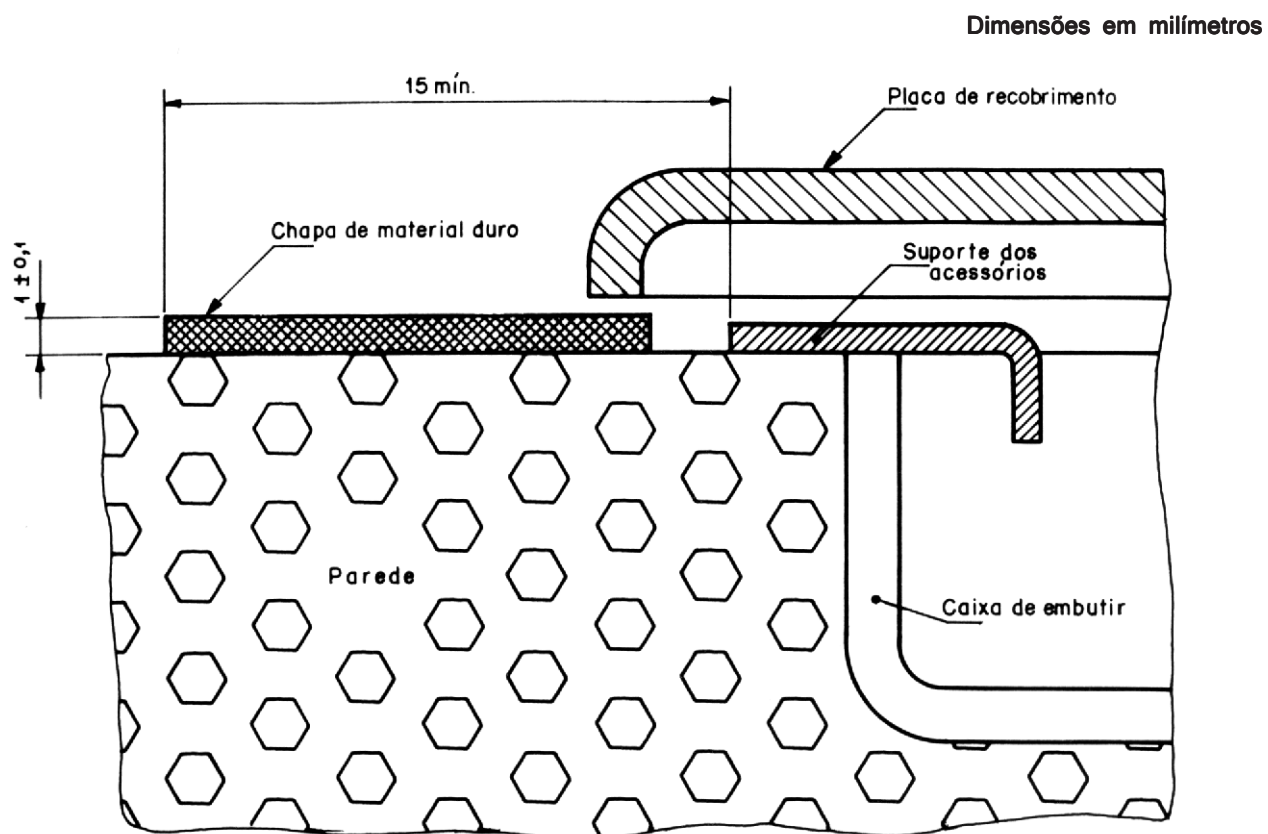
Disposição para o ensaio das tampas ou placas de recobrimento
